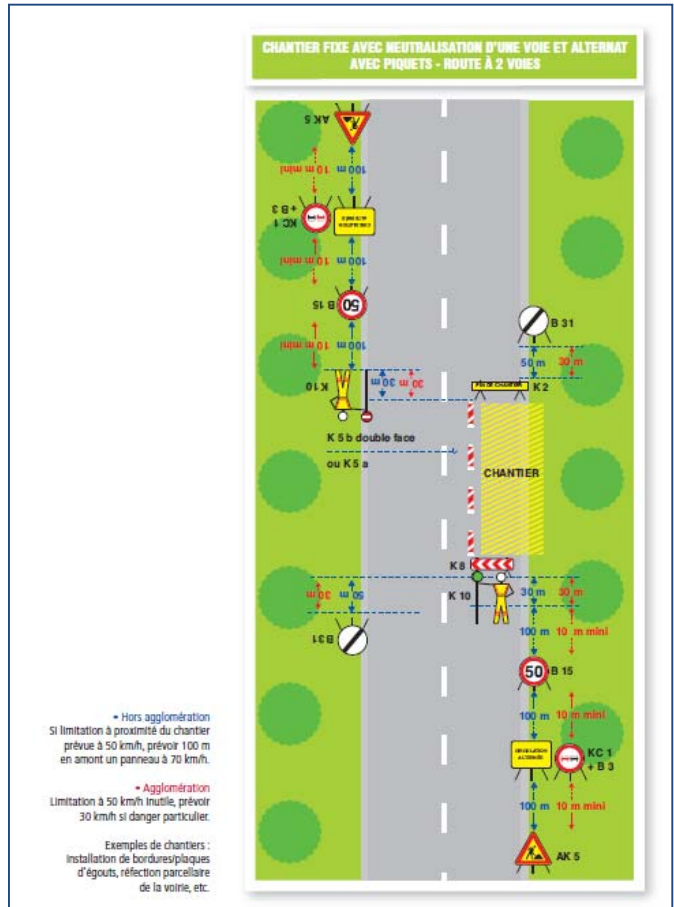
Exemple d'une signalisation temporaire d'un chantier fixe avec neutralisation d'une voie et alternat avec piquets
